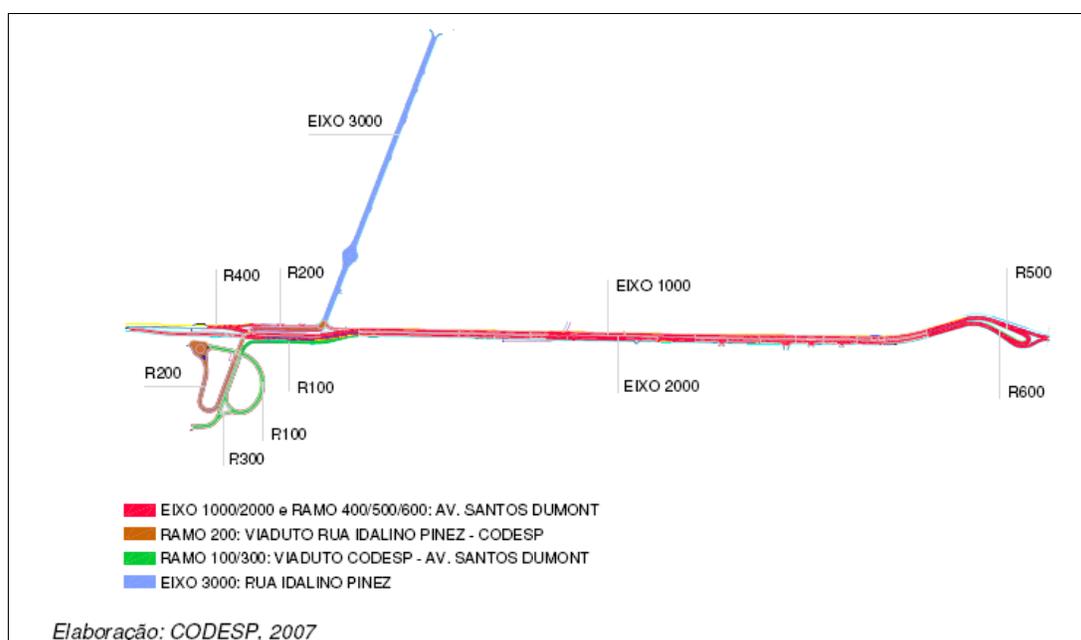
2: Intervenções previstas para a Avenida Perimetral da Margem Esquerda
